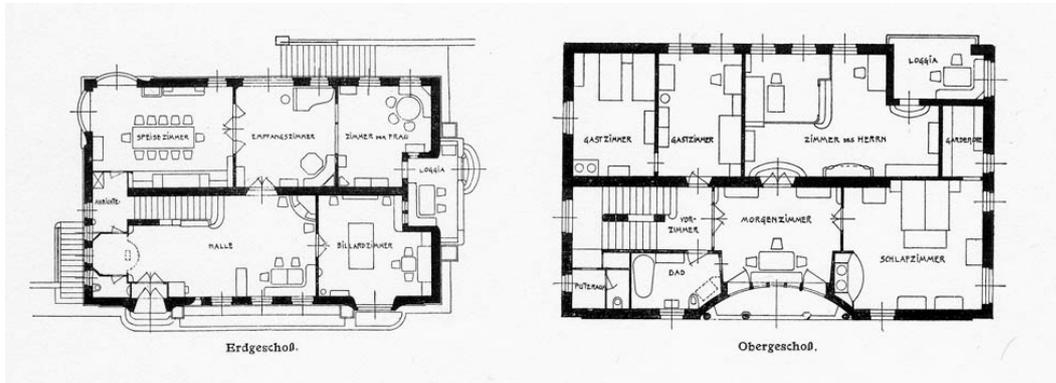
Haus Thonet. Grundrisse von Parterre und 1. Stock. 1908.
